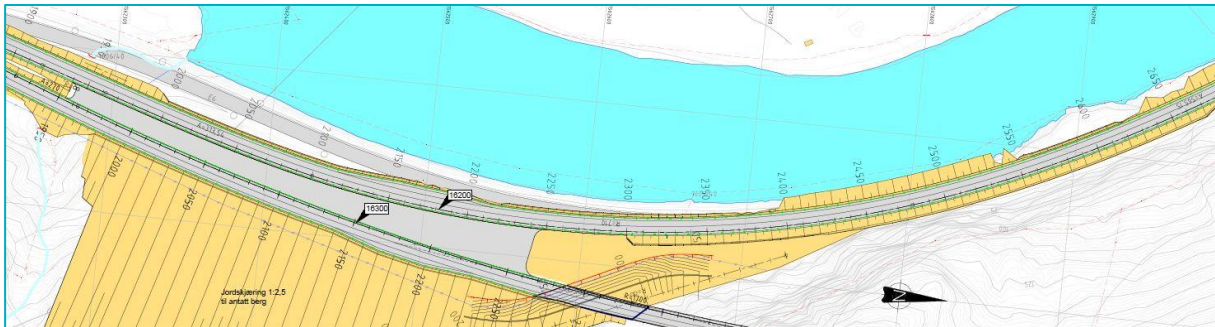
Tunnelportal i sør – utsnitt fra teknisk plan.
